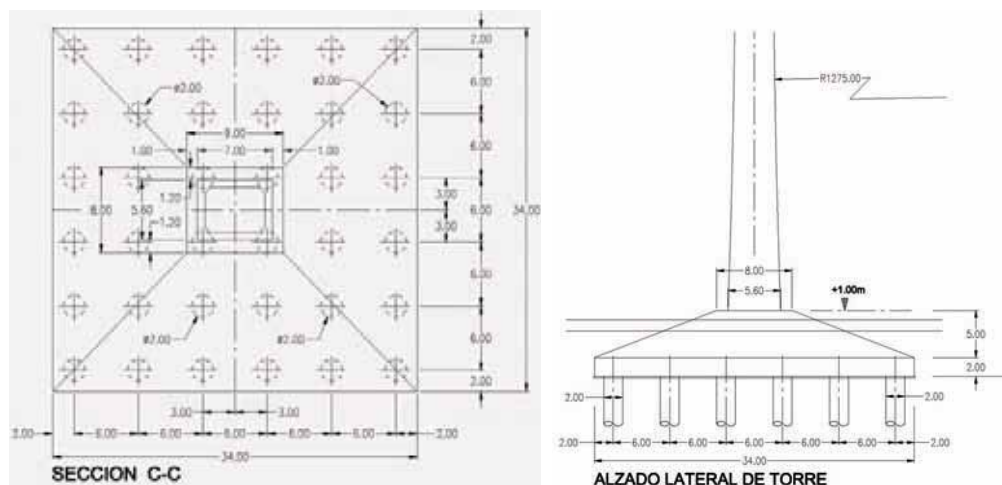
Encepado de las pilas principales de la cimentación del Puente sobre la ría del Odiel.
